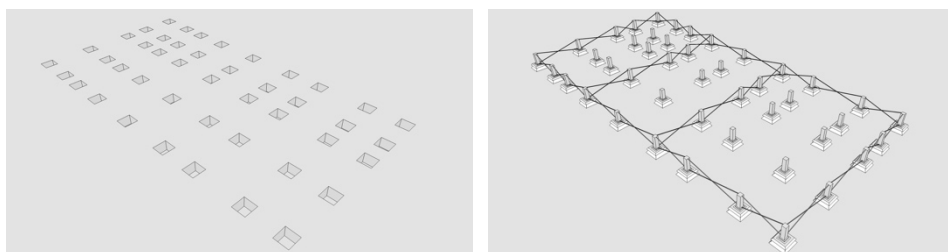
e 48 Execução das fundações (sapatas com contraventamento)
